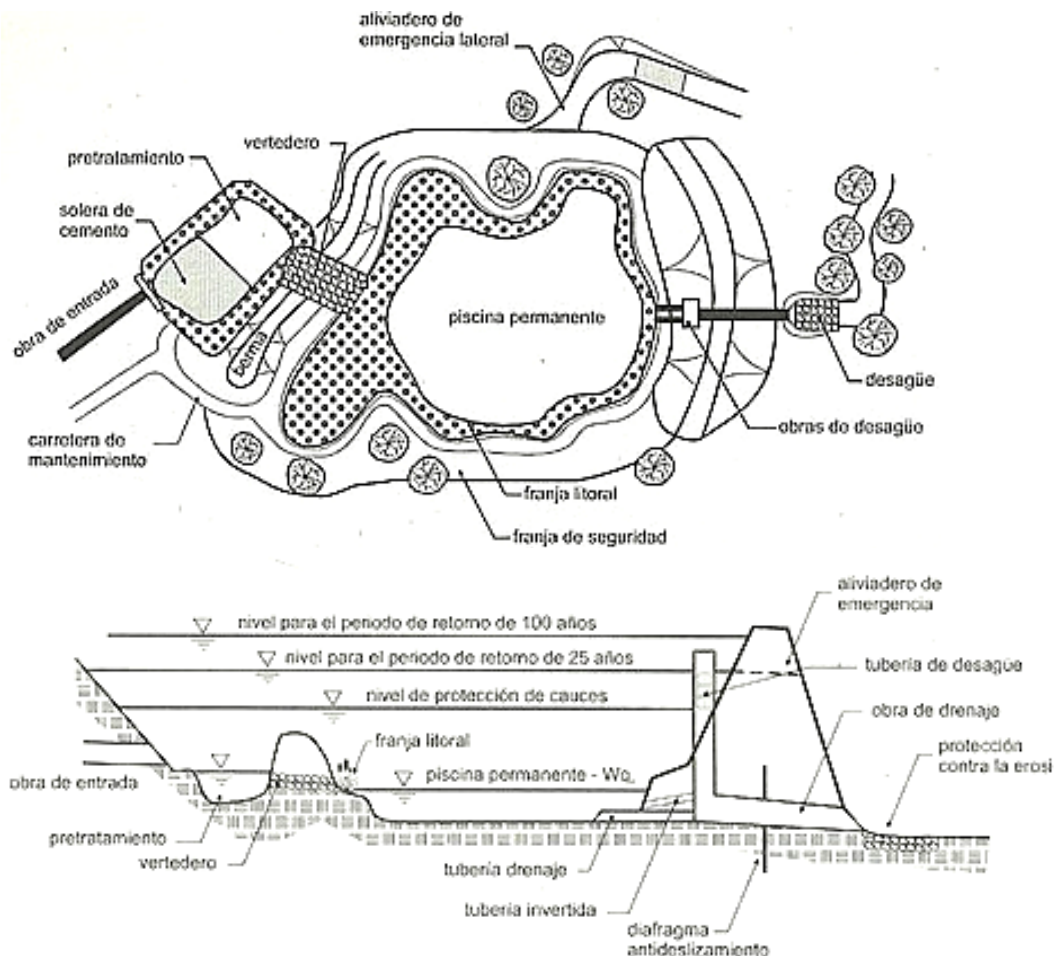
Esquema de la planta y el perfil de un estanque de retención. Fuente: CEDEX (2008).
